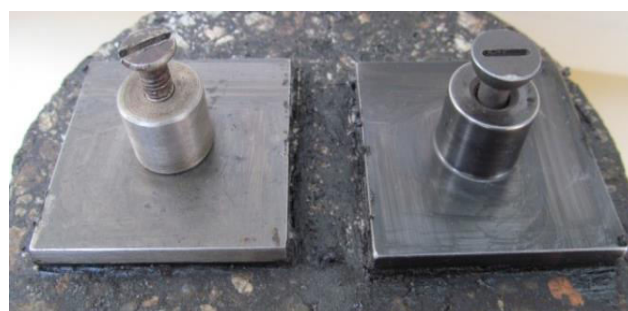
Загальний вигляд підготовленого до випробування зразка
